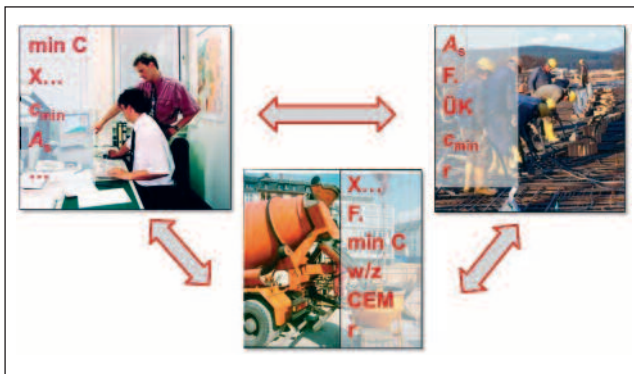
Verknüpfung der Teilprozesse Planung, Betonherstellung und Bauausführung im Betonbau
